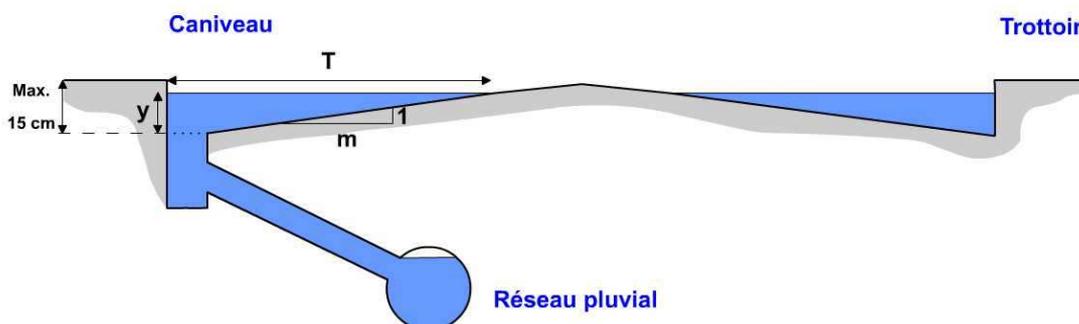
section en travers et profil en long type du système d'assainissement dual.
